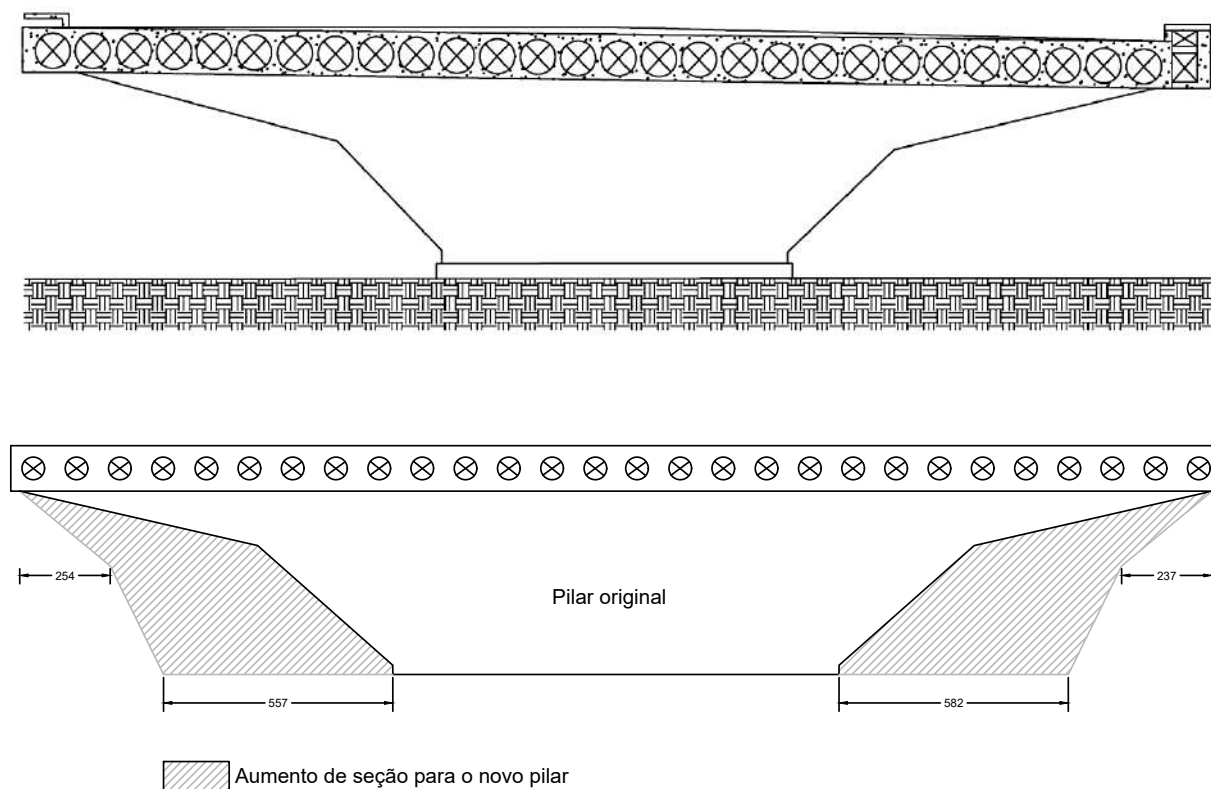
Cortes da estrutura do viaduto antes e após Retrofit estrutural, mostrando a seção transversal do pilar e do tabuleiro protendido. Fonte: autoral
